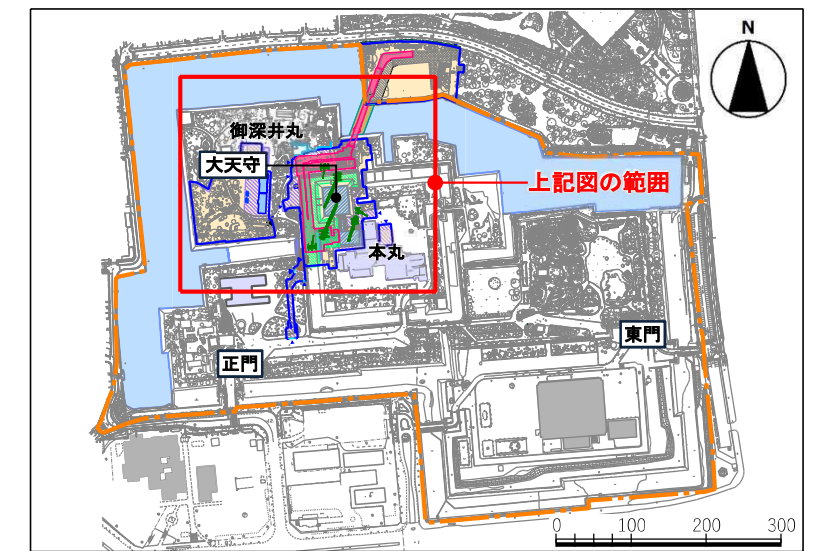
現天守閣解体工事時の平面図(敷地全体)
